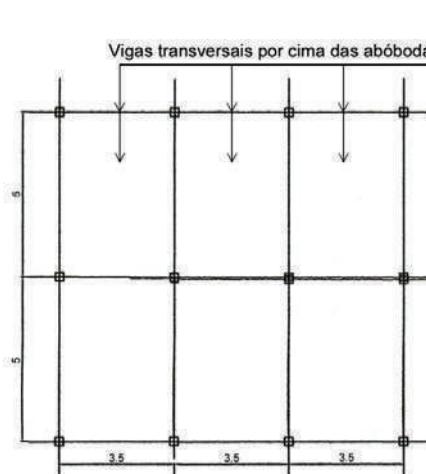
Planta baixa da estrutura, as vigas transversais estão por cima das abóbodas. (*-5).
